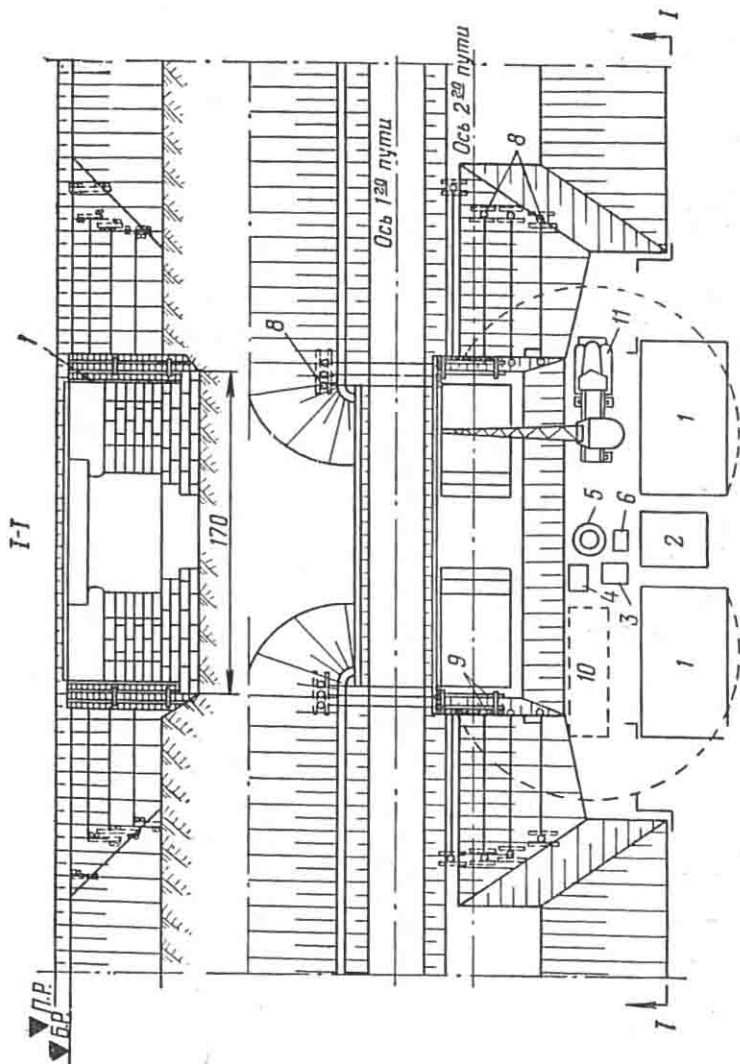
Схема строительной площадки по сооружению блочного моста при строительстве вторых путей:
